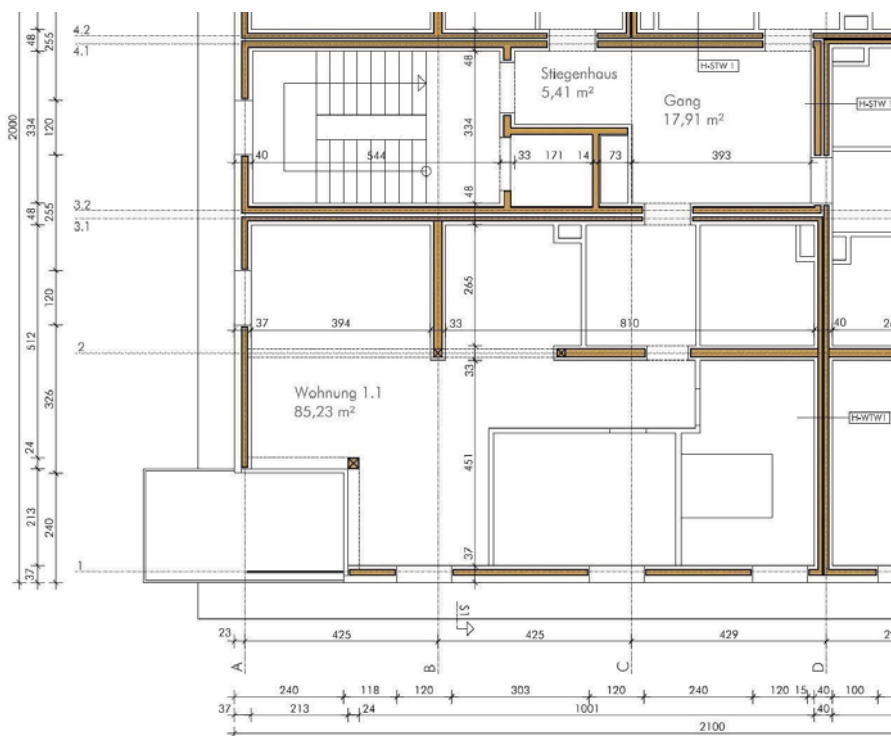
Ausschnitt Grundriss Holzbauweise
